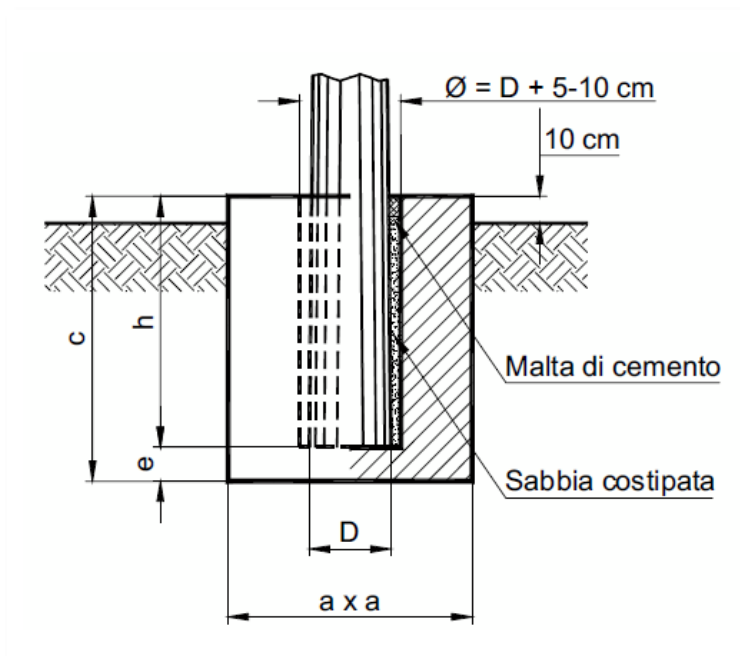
Particolare costruttivo delle opere di fondazione dei sostegni
